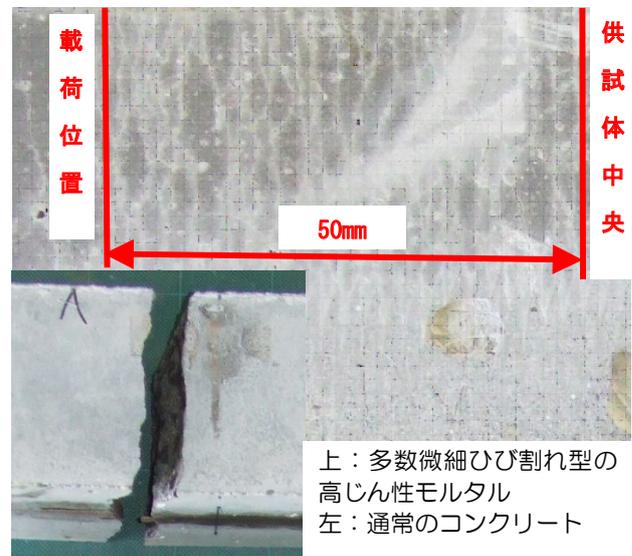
曲げ強度試験後に発生するひび割れの状況
